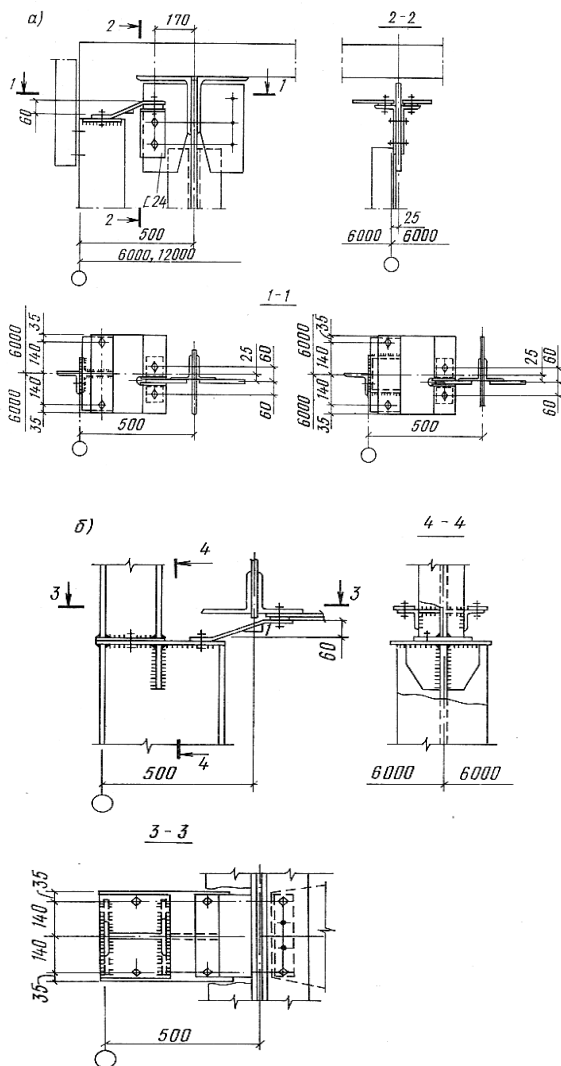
Узлы крепления стоек фахверка к покрытию:
